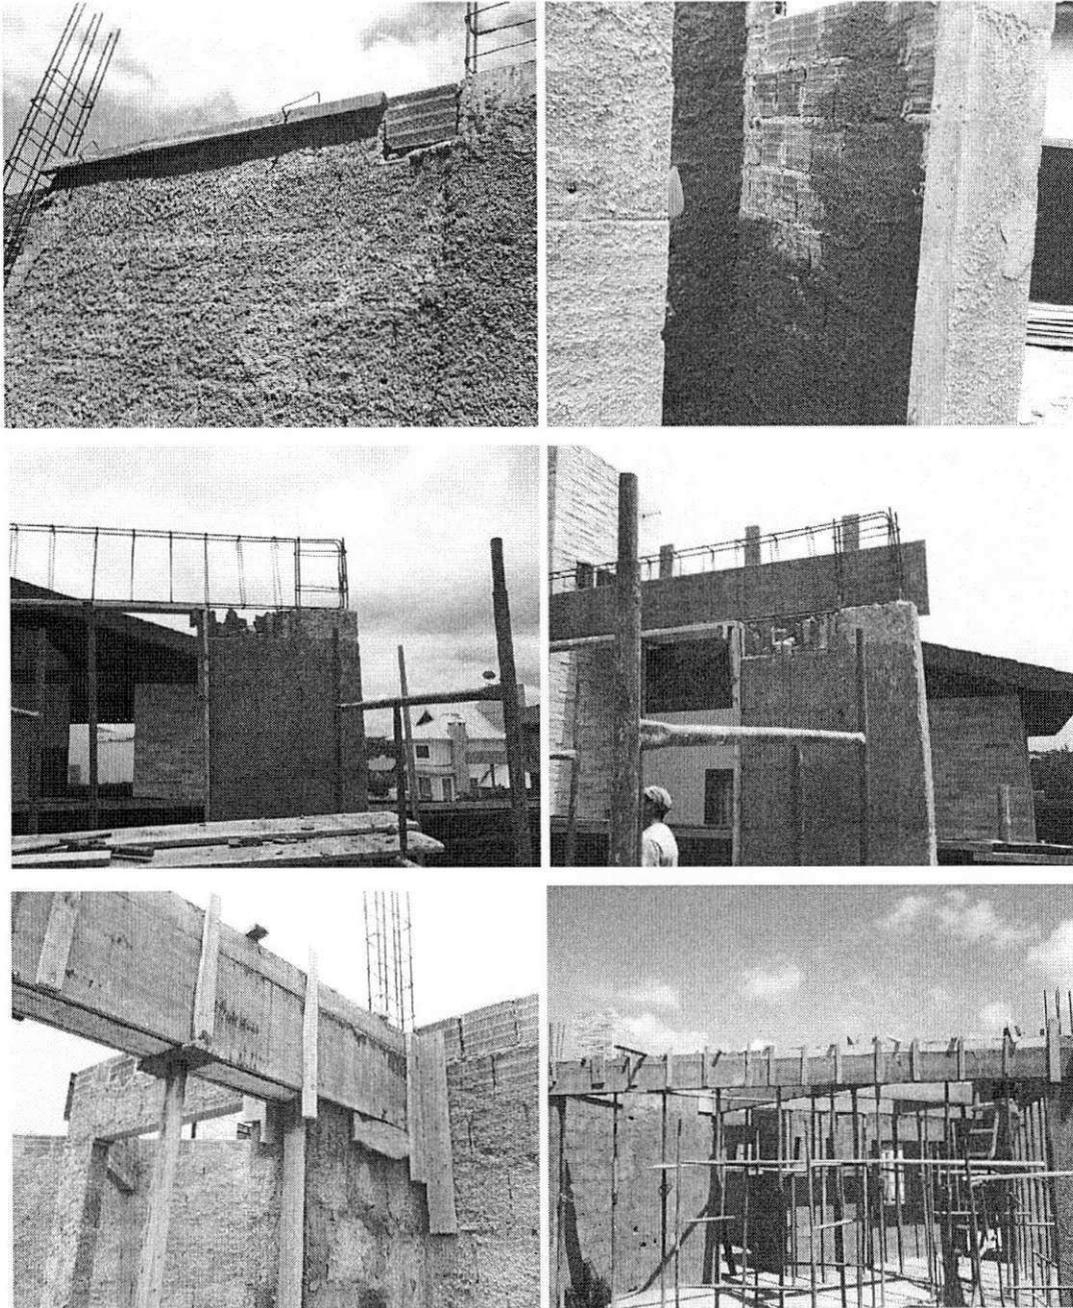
a 61 – Impermeabilização das cintas, colocação das ferragens e das fôrmas dos pilares e concretagem.
